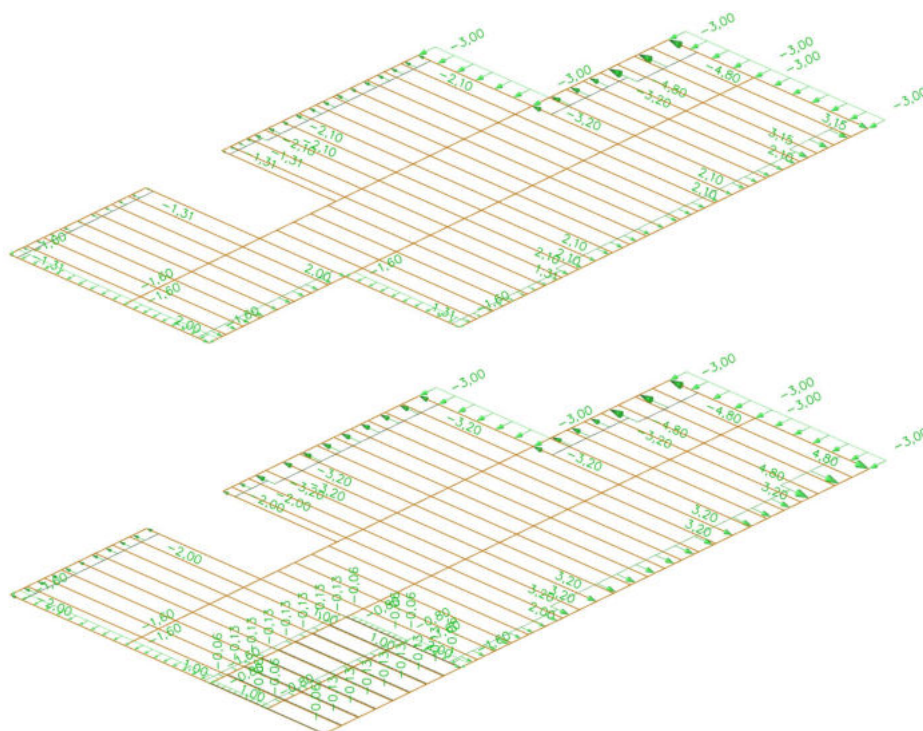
Zatížení stropní konstrukce příčným větrem zleva 2
